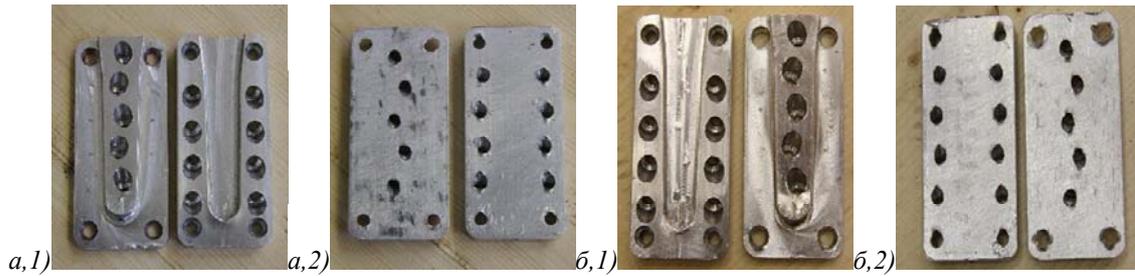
Виды разрушения металлических накладок в элементах деревянных конструкций:
